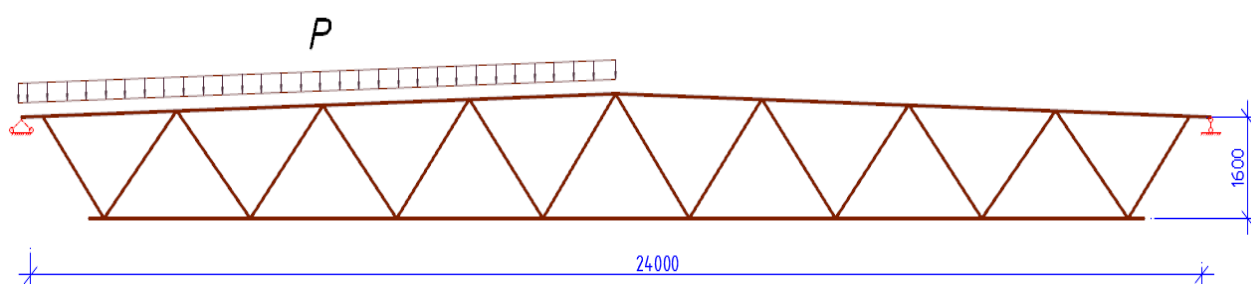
Схема загрузки стропильной фермы снеговой нагрузкой слева
